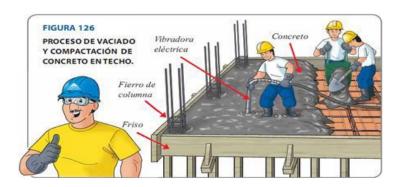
Vaciado de concreto para losa aligerada. Nota. Orihuela, J. et al. (2010)
